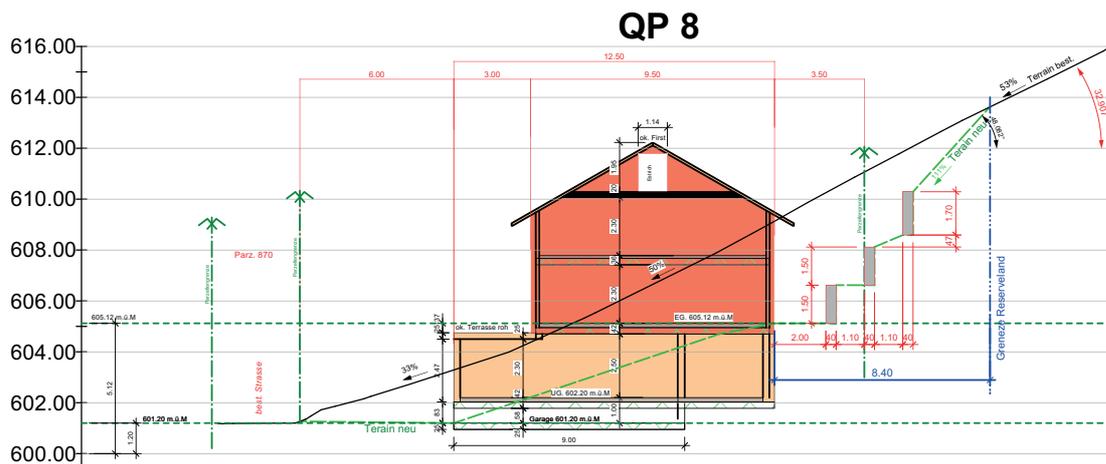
Querprofil QP 8 (Quelle: Emanuel Haldi Planung/Bauführung)
